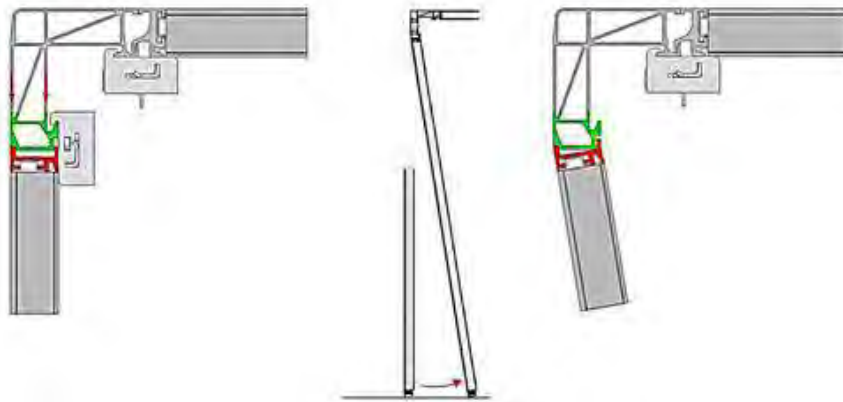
Paneles de transición (Conexión Muros – Vigas)
